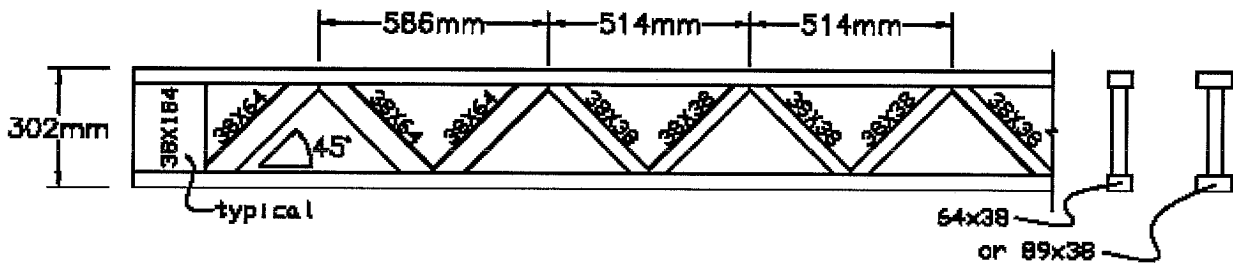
OPEN JOIST 2000 – HAUTEUR 302 mm
